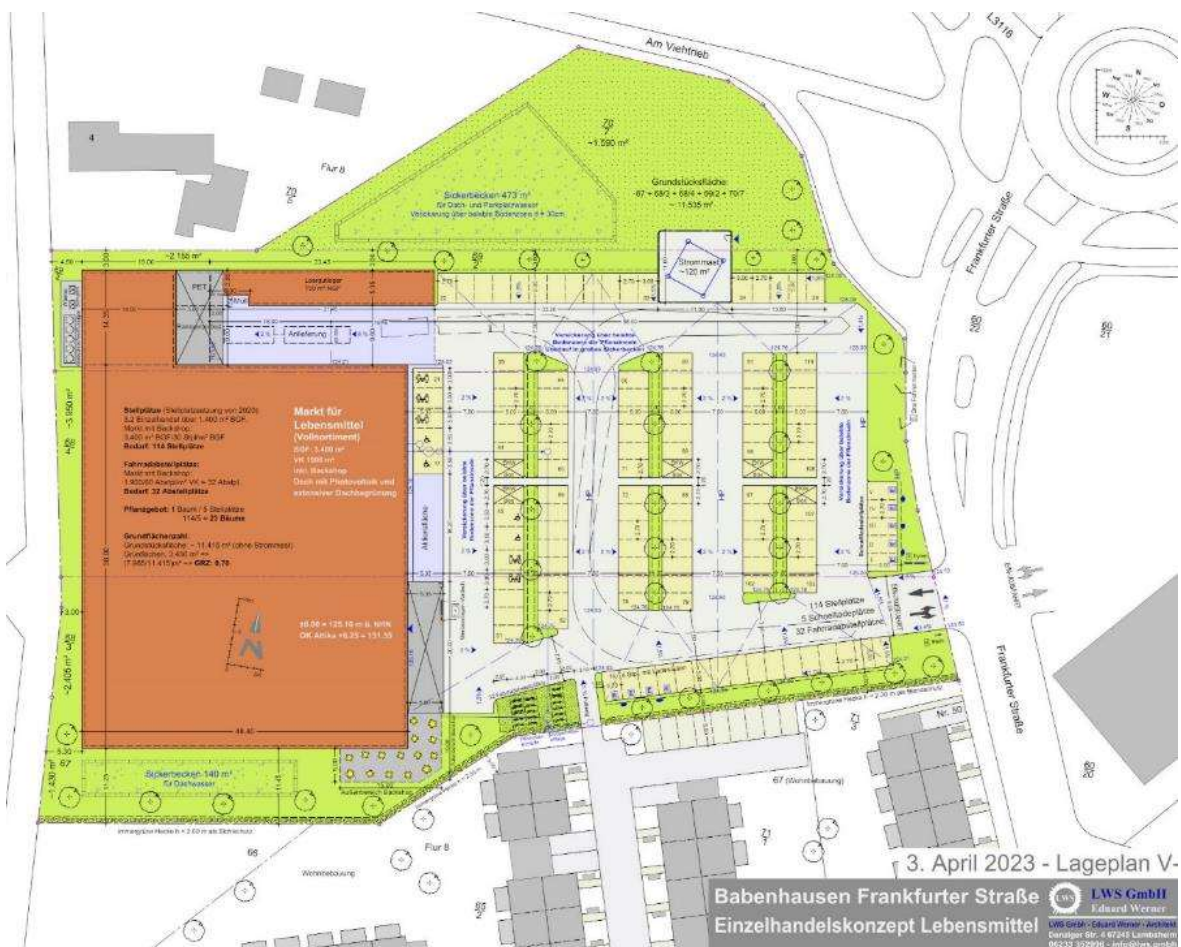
Lageplan des Vorhabens (Quelle : CMB PA GmbH & Co KG)
